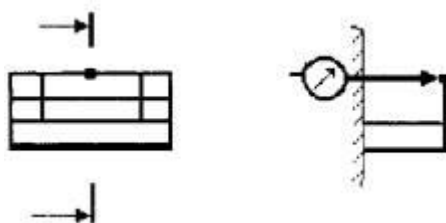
Ограждения лестниц, маршей площадок и кровли
